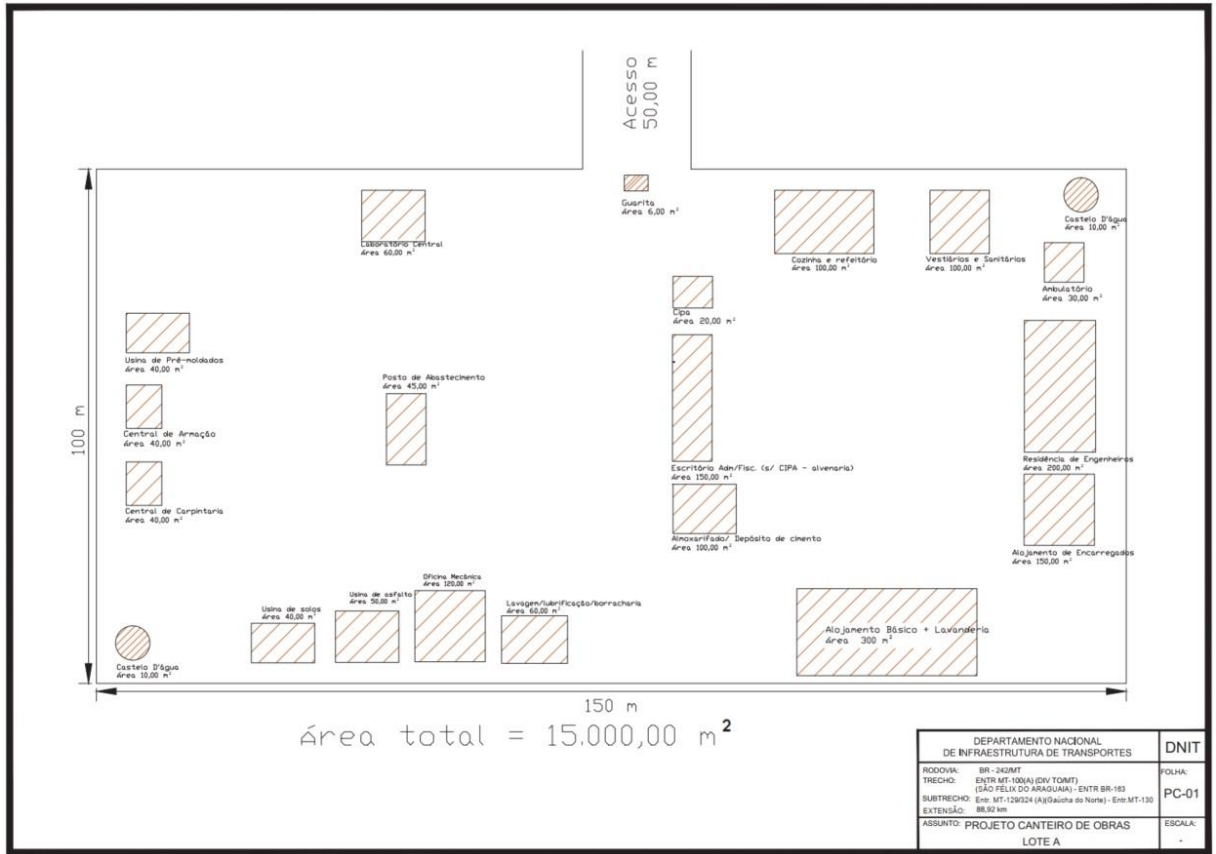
Estrutura prevista para o canteiro de obras no Segmento A da BR-242/MT.
